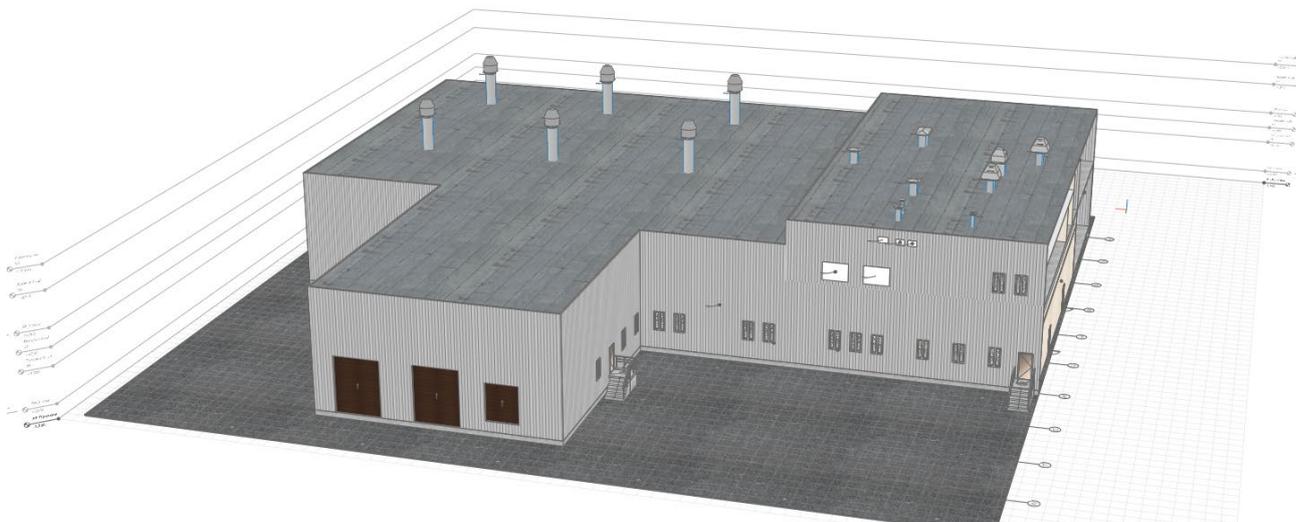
Общий вид корпуса предубойного содержания с текстурами.
